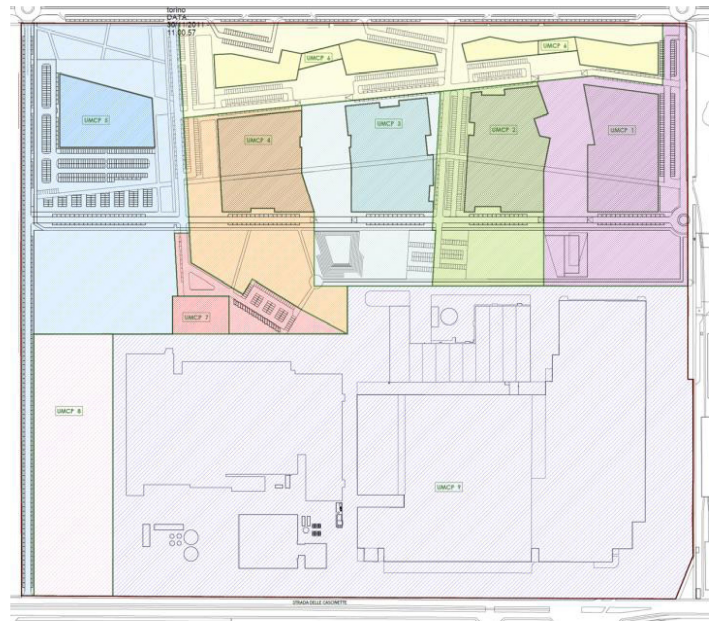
5 - Planimetria generale con individuazione delle UMCP
